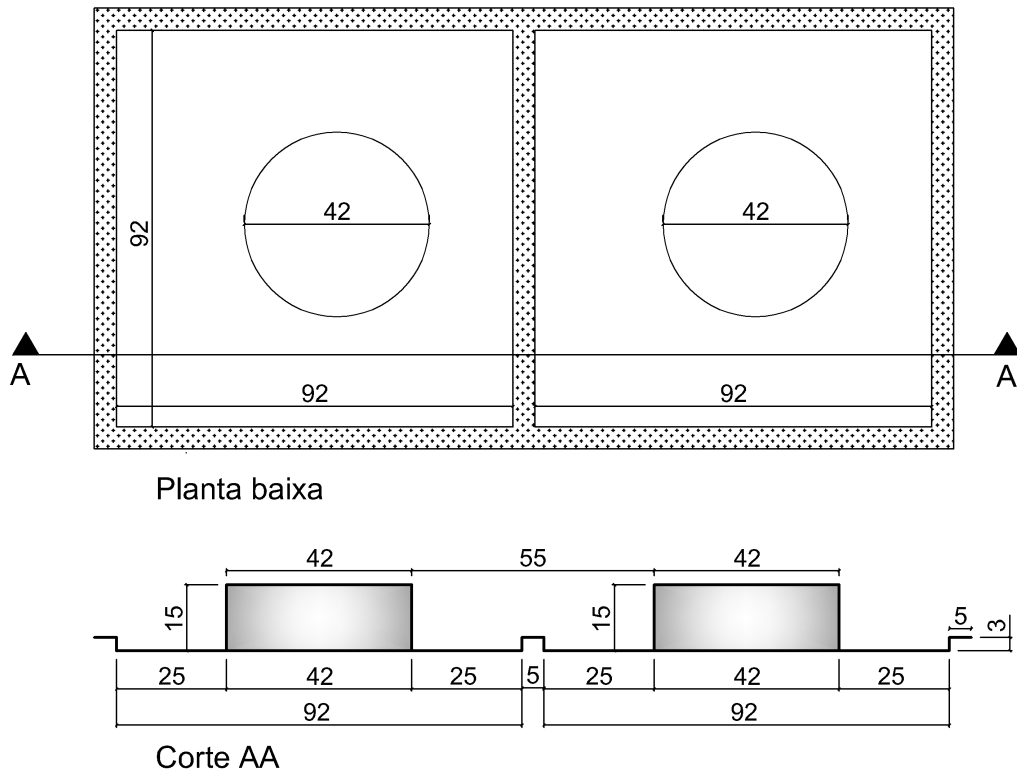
Planta baixa e corte referente a um parque de tanques verticais não isolados em bacias de contenção separadas.
